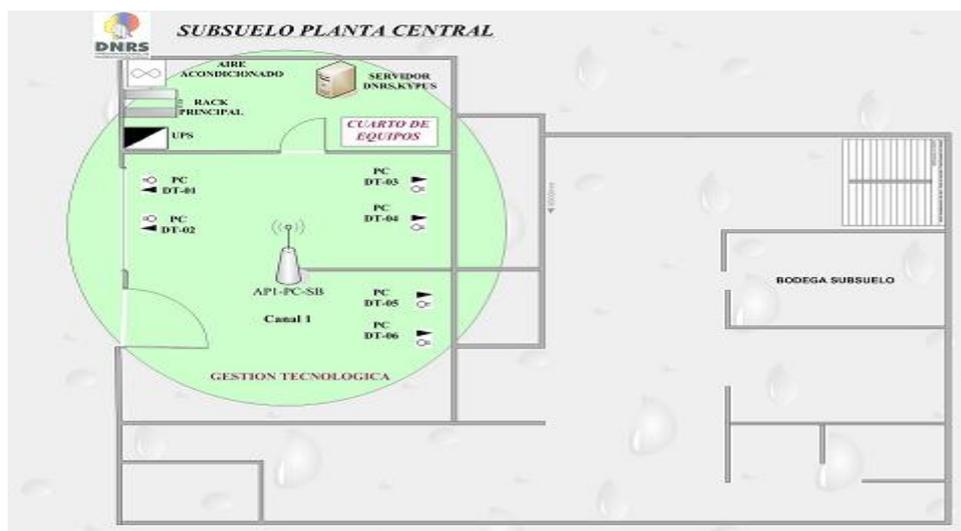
Red Inalámbrica Subsuelo Planta Central
